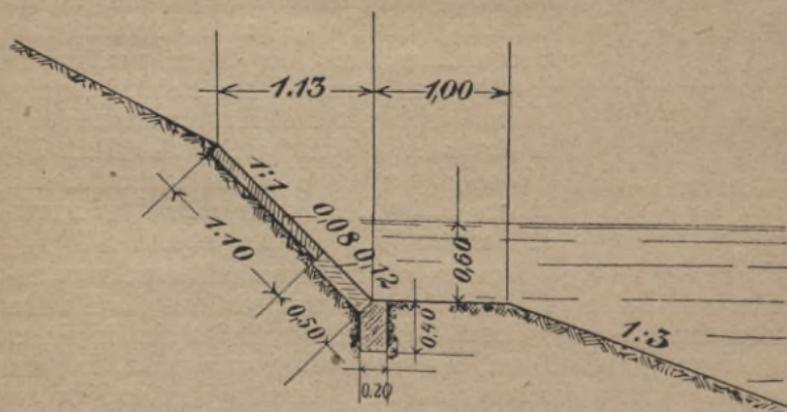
Uferbefestigung mit Betoneisenplatten am Oder—Spree-Kanal mit Sicherung des Fußes durch Betonmäuerchen.
